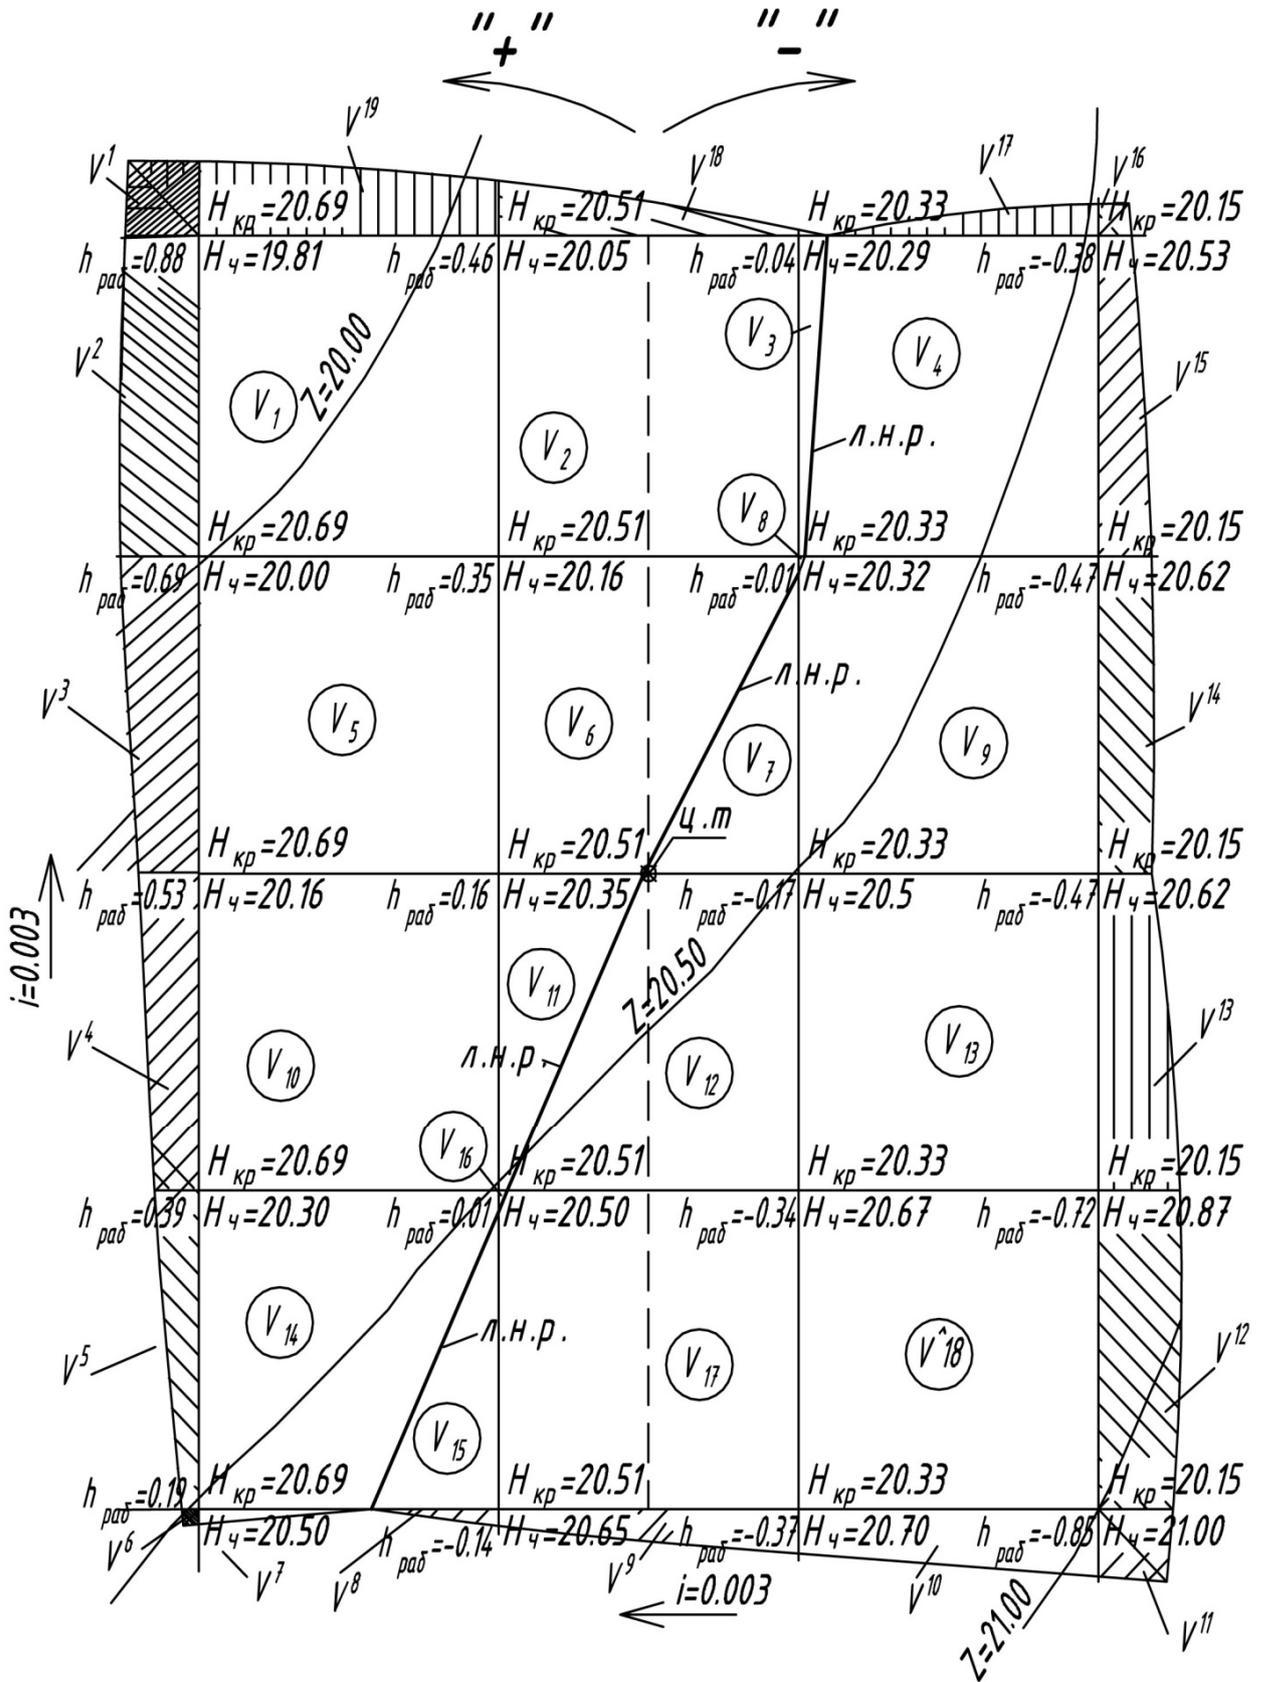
План вертикальной планировки с обозначенными объемами, которые необходимо определить
